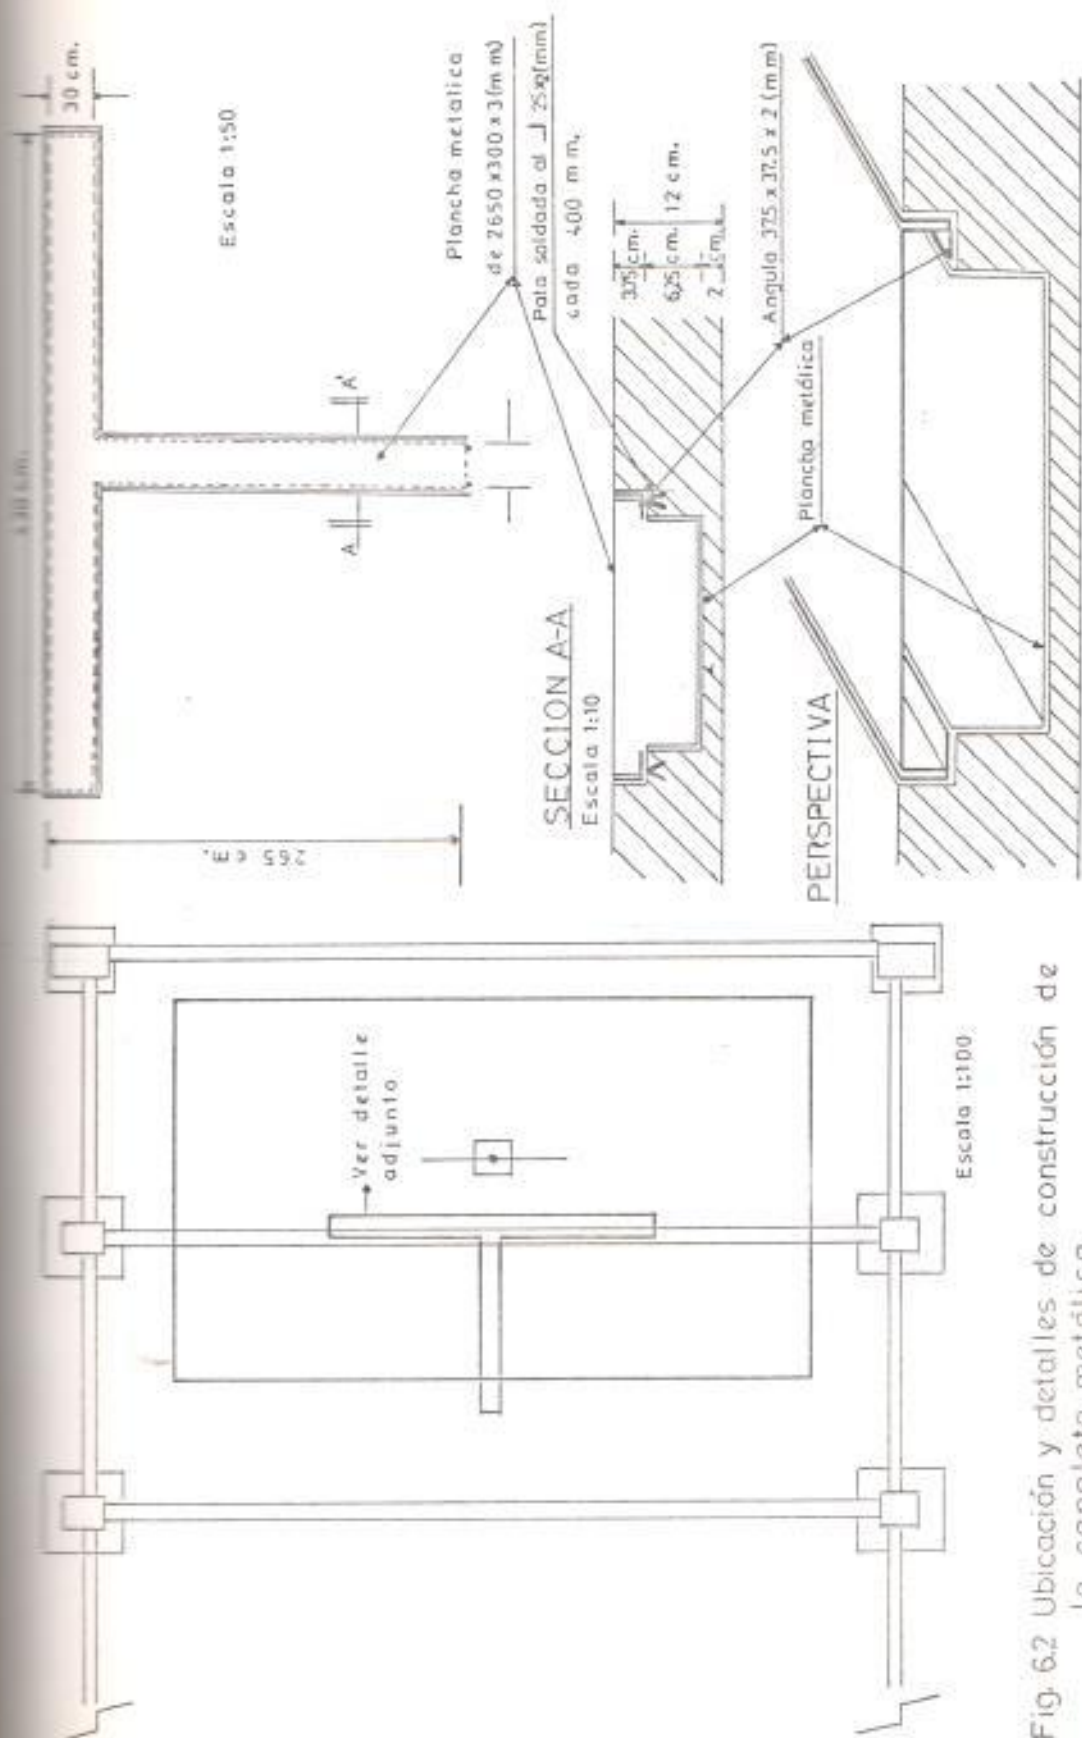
Ubicación y detalles de construcción de la cancheta metálica
